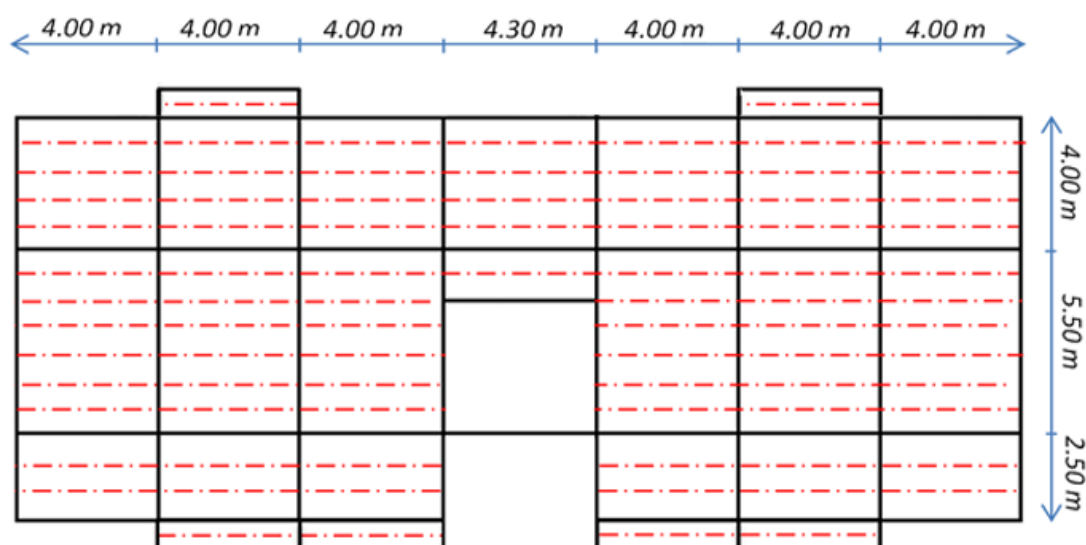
Types des poutrelles pour RDC ,1ere, 2eme, 3eme étage
